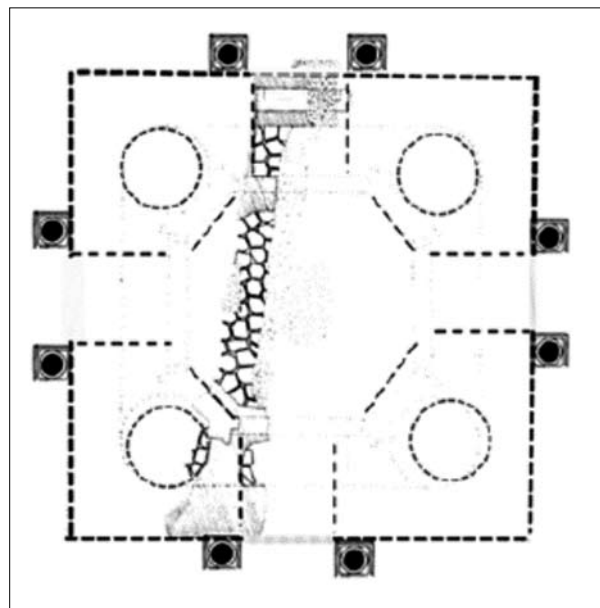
Pianta di sant'Ilario secondo BUORA 2020.
